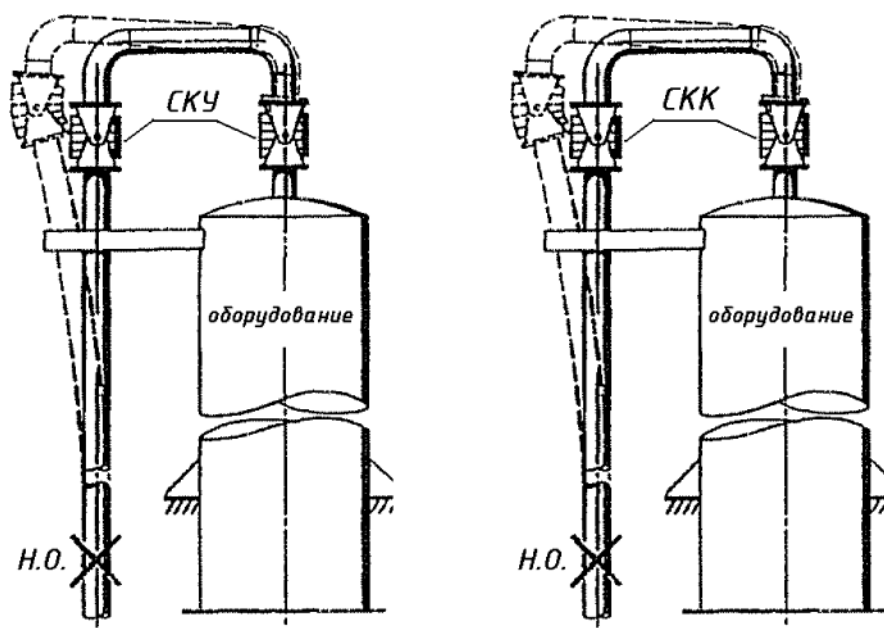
Использование углового или карданного компенсатора с оборудованием
